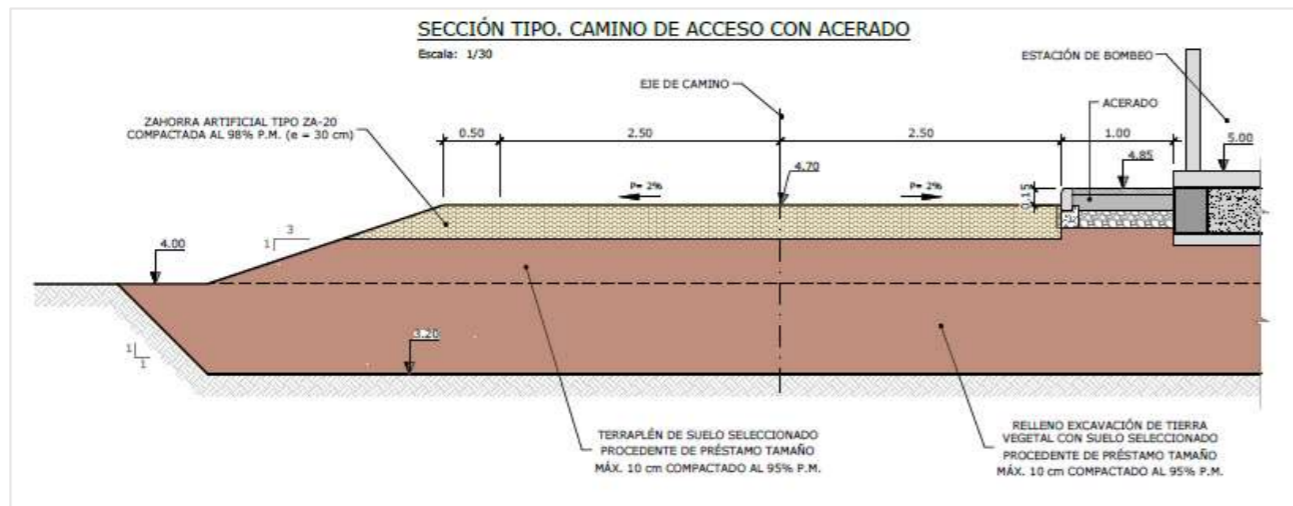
Detalle sección tipo de explanada de urbanización. Sector Palmillas
